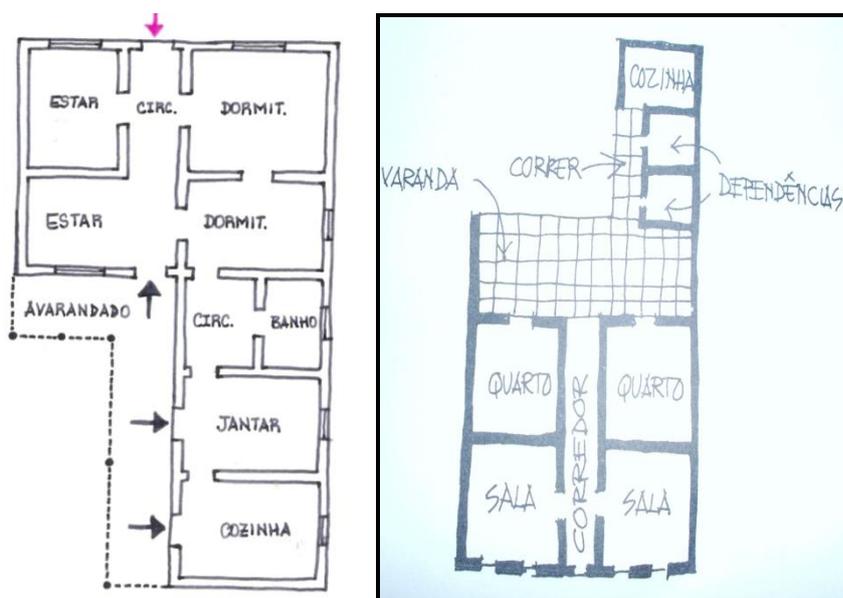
Planta baixa esquemática de uma casa de morada-inteira.
